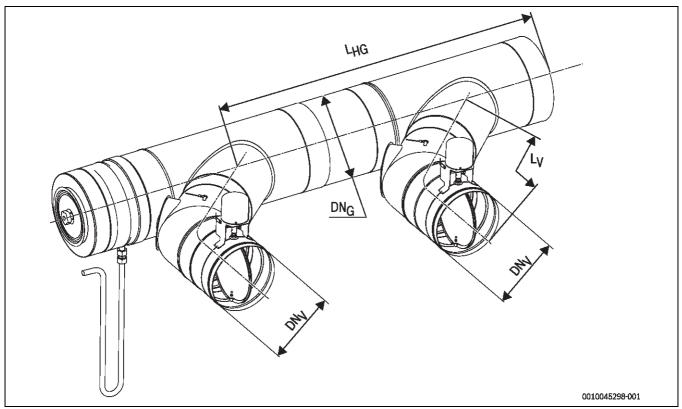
Aufbau der Kaskade hinter dem Kessel (Beispiel; Einzel-Kesselgröße 350 ... 500 kW)
